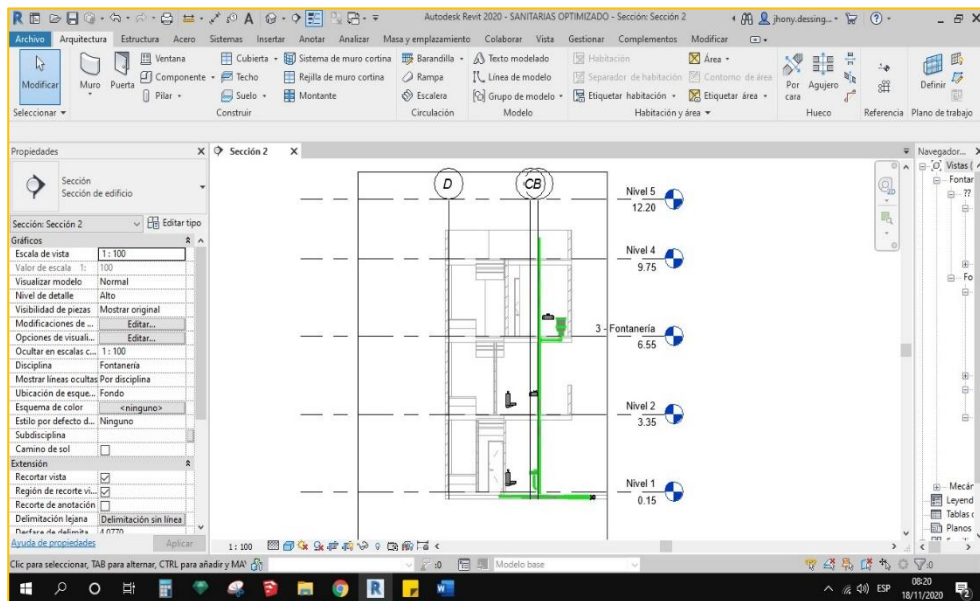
Vista en elevación de bajada de montante de 4” hacia niveles inferiores.
